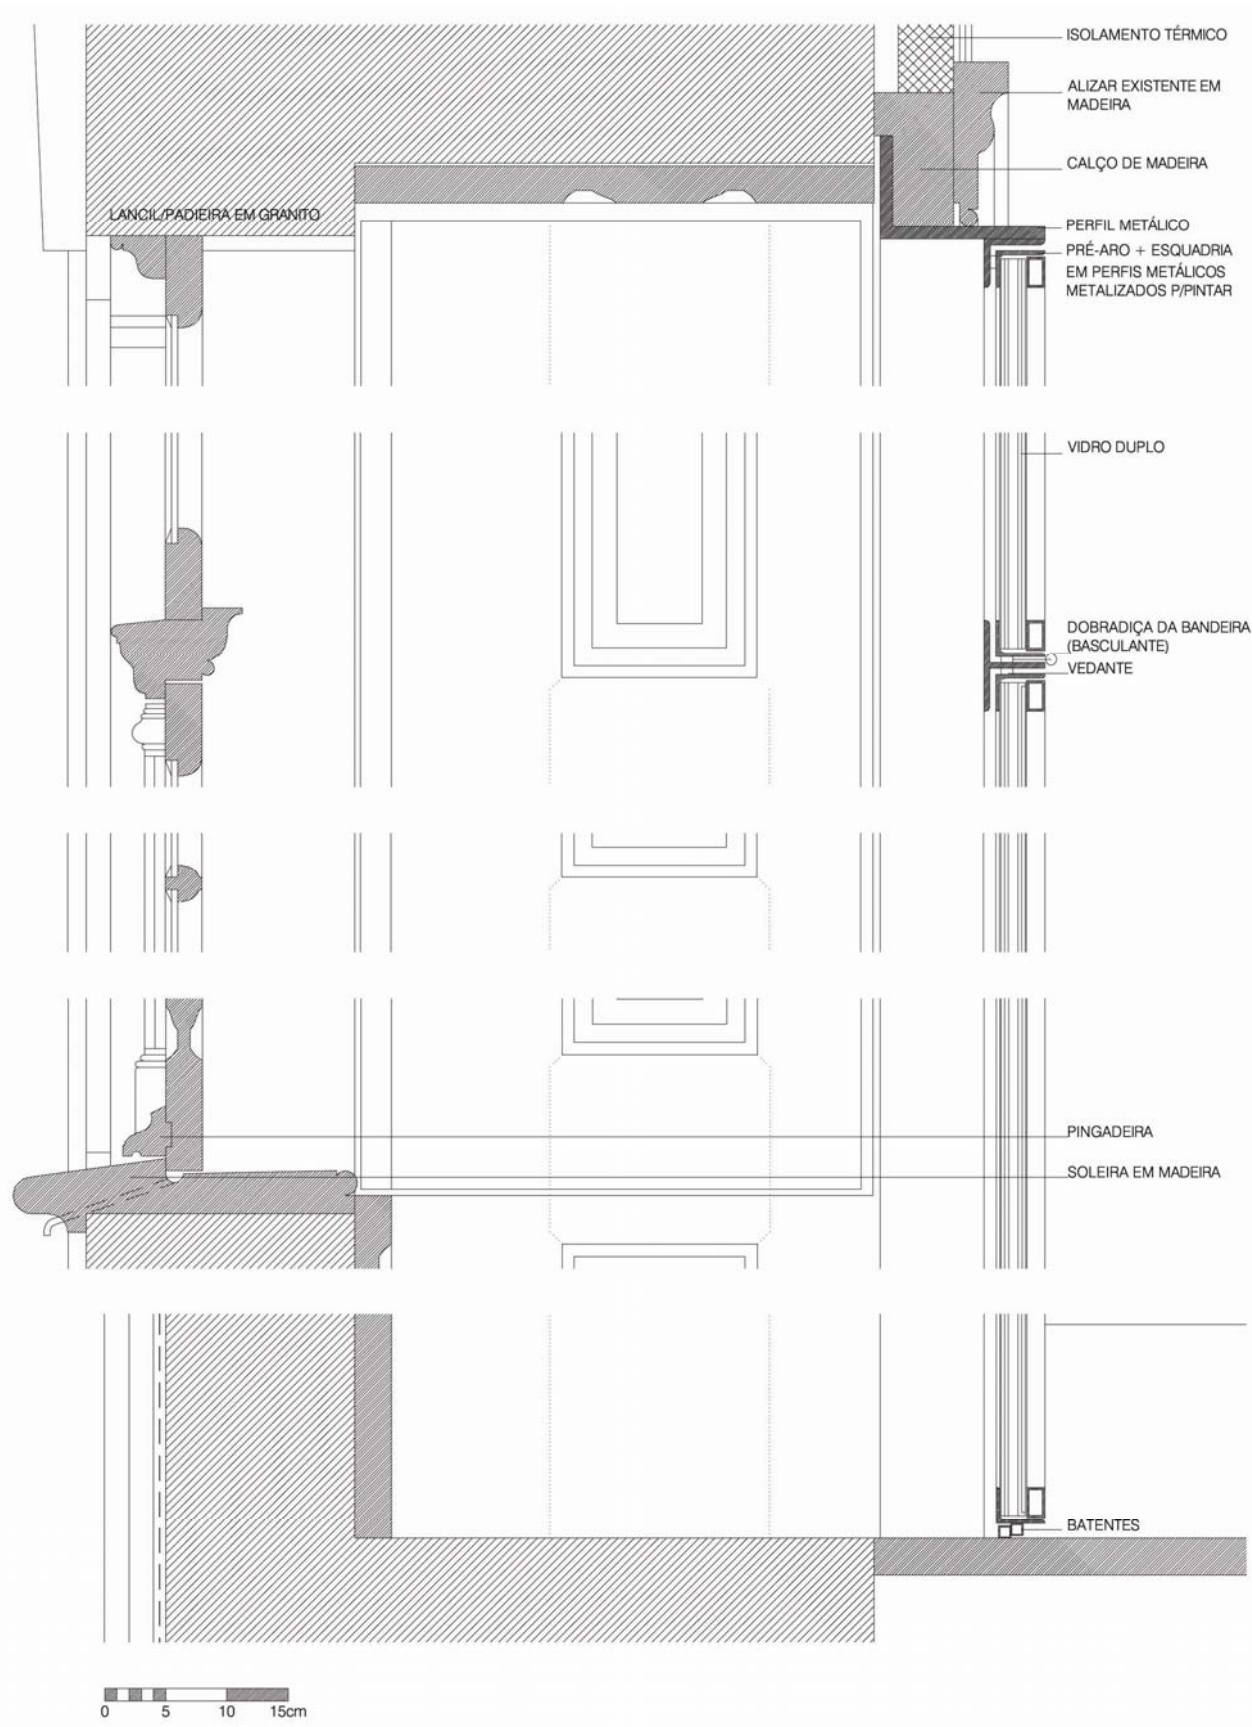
Conservação da caixilharia existente e introdução de uma segunda caixilharia interior - pormenor do corte vertical.
